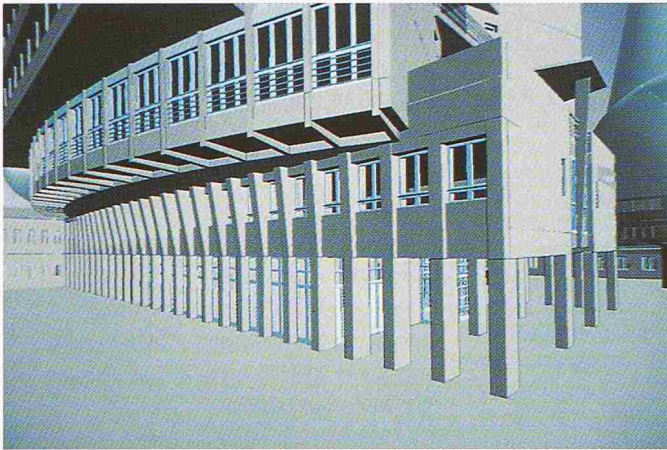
Überprüfung Fassadendetails mit der Visions-Animation (Projekt Tertianum Adlerberg, St. Gallen)
